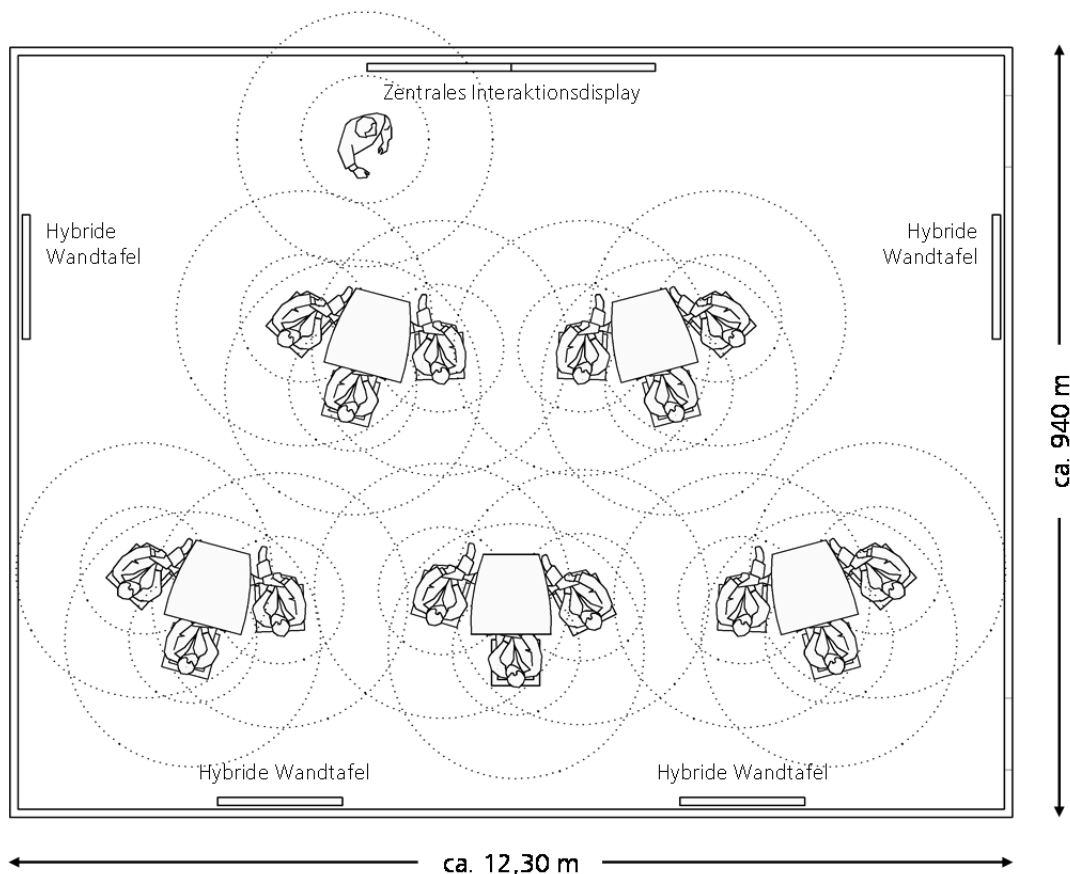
Modul 6 (Lecture), frontale Anordnung, Grundrissdarstellung
